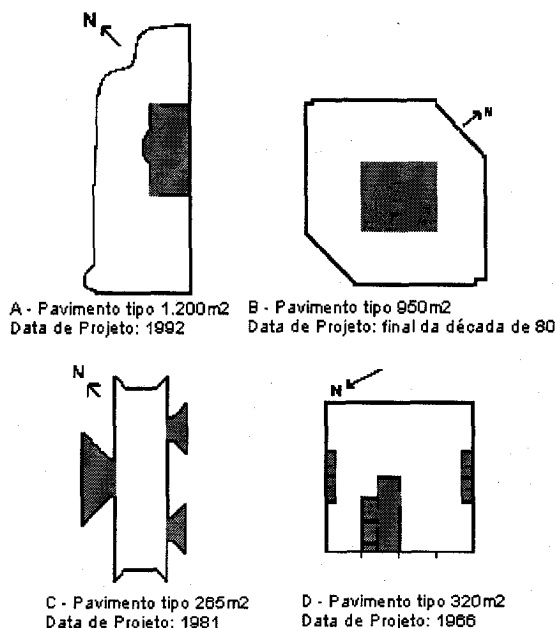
Os estudos de caso: lay-out do pavimento tipo com localização dos setores de serviços e infraestrutura.
